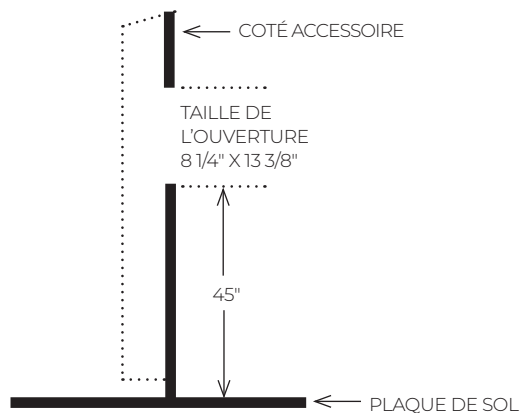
FIGURE B – ENLEVER LA PLAQUE PRÉPERCÉE
